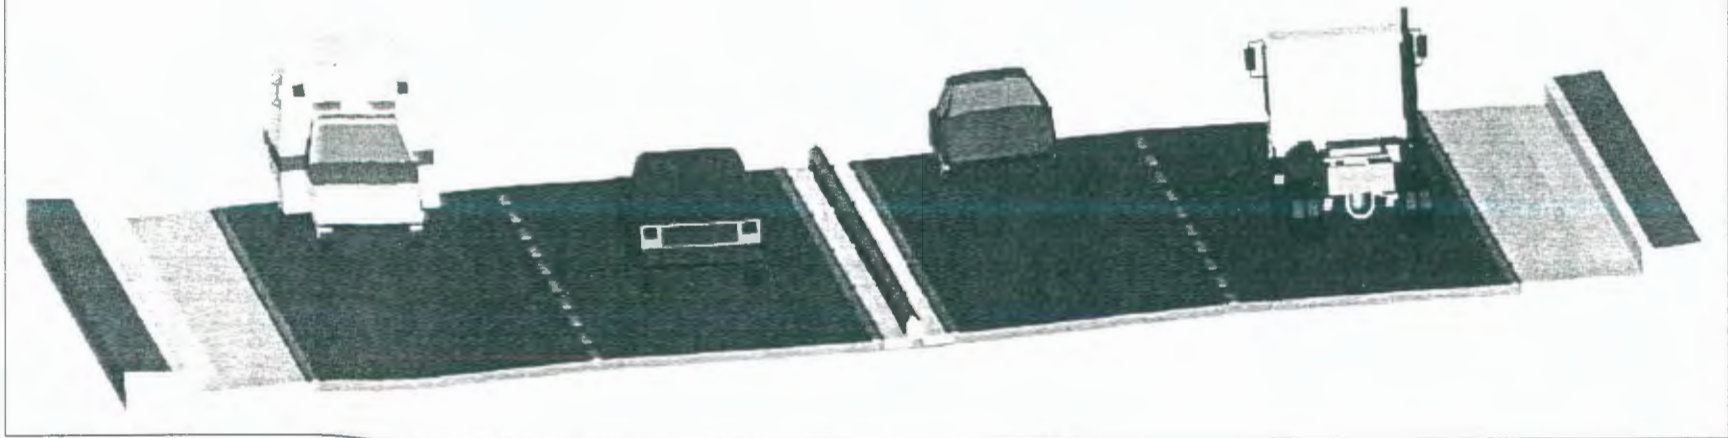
ALTERNATIVA DE SECCIÓN TRANSVERSAL TIPO III
